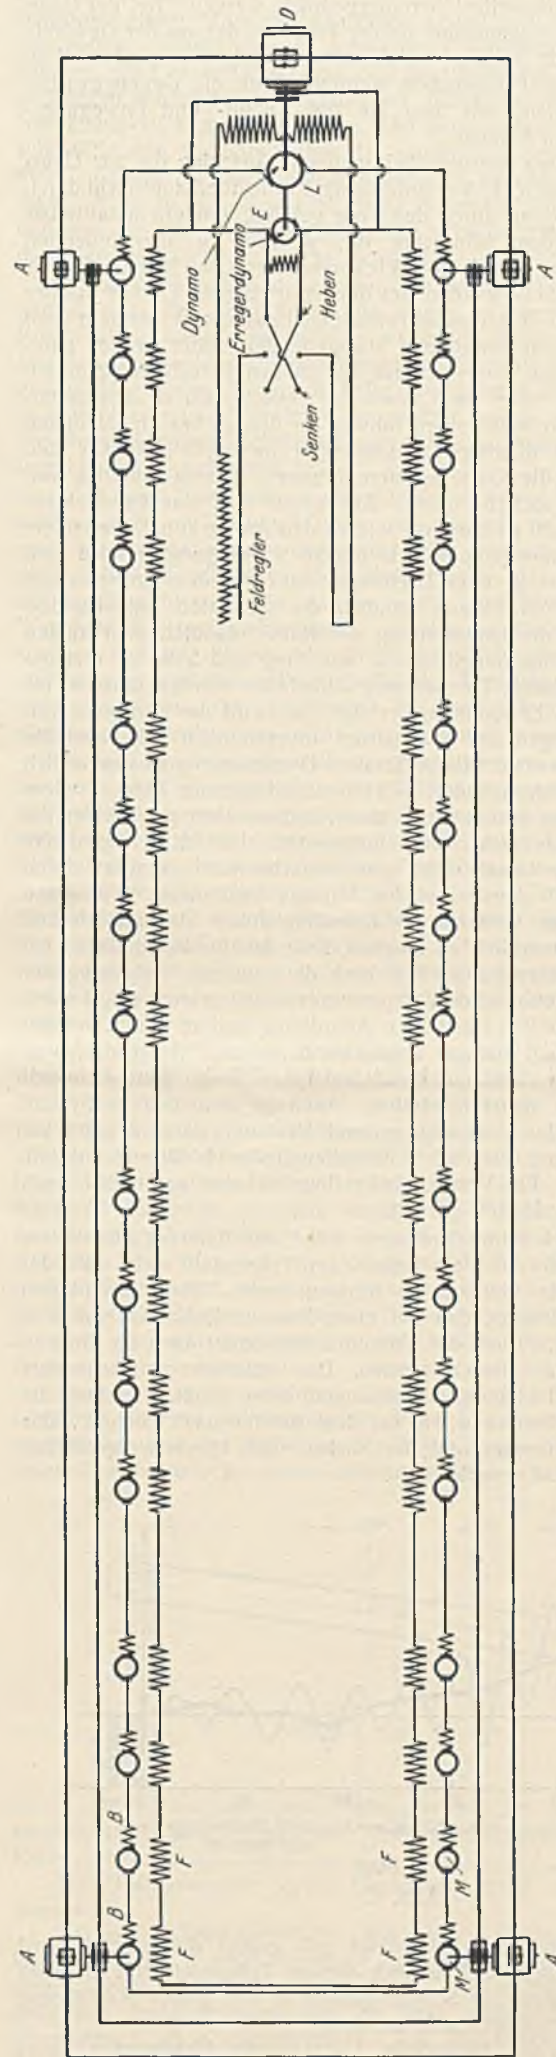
Grundriß des Schiffshebewerkes, Seil- und Kettenwindenanordnung.
